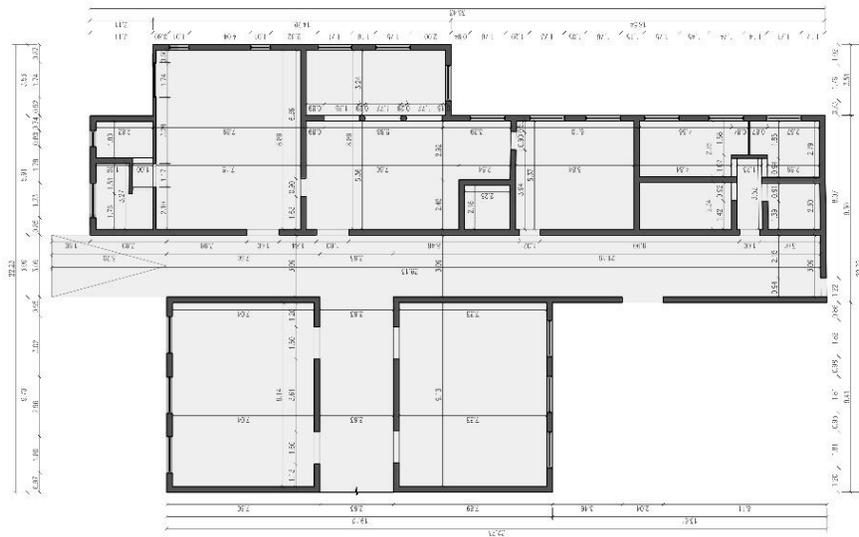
Planta Constructiva Área de Sostenibilidad
